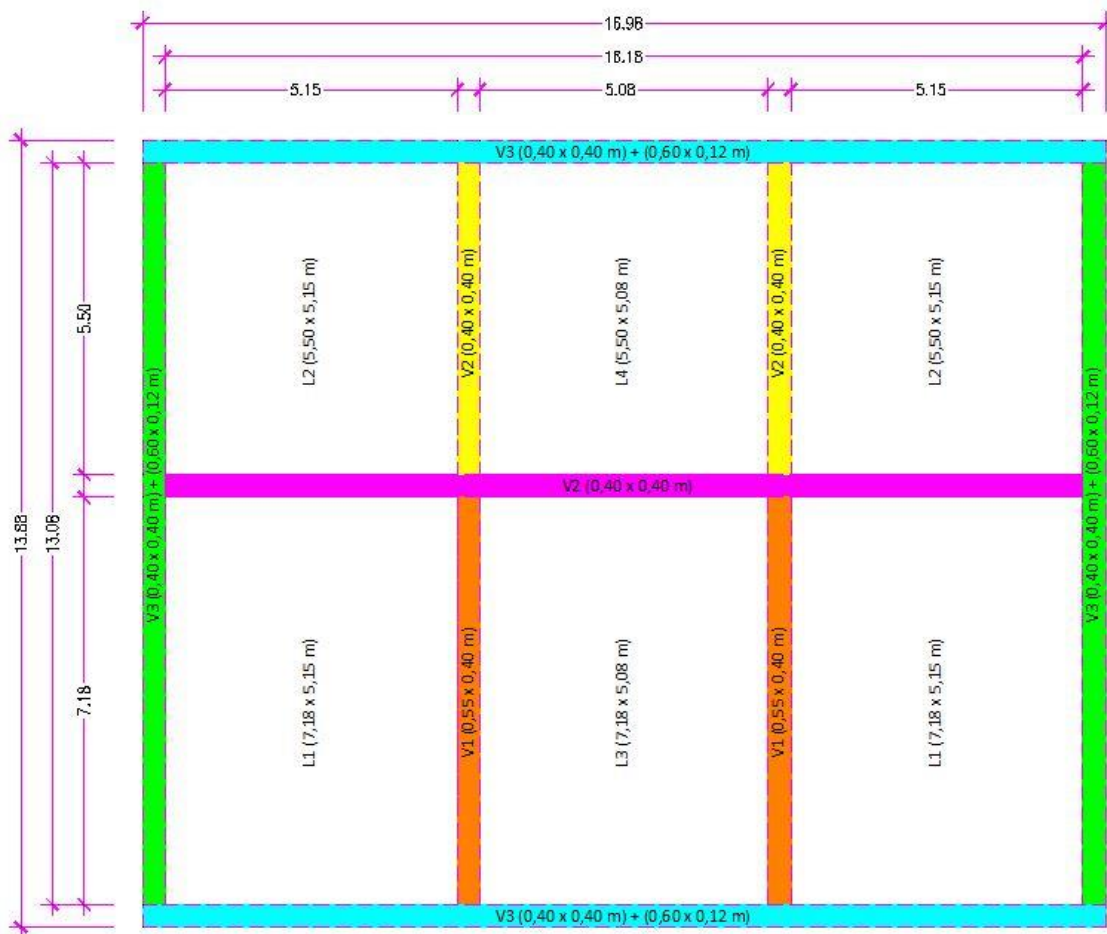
Identificação de vigas e lajes do plano de cofragem
